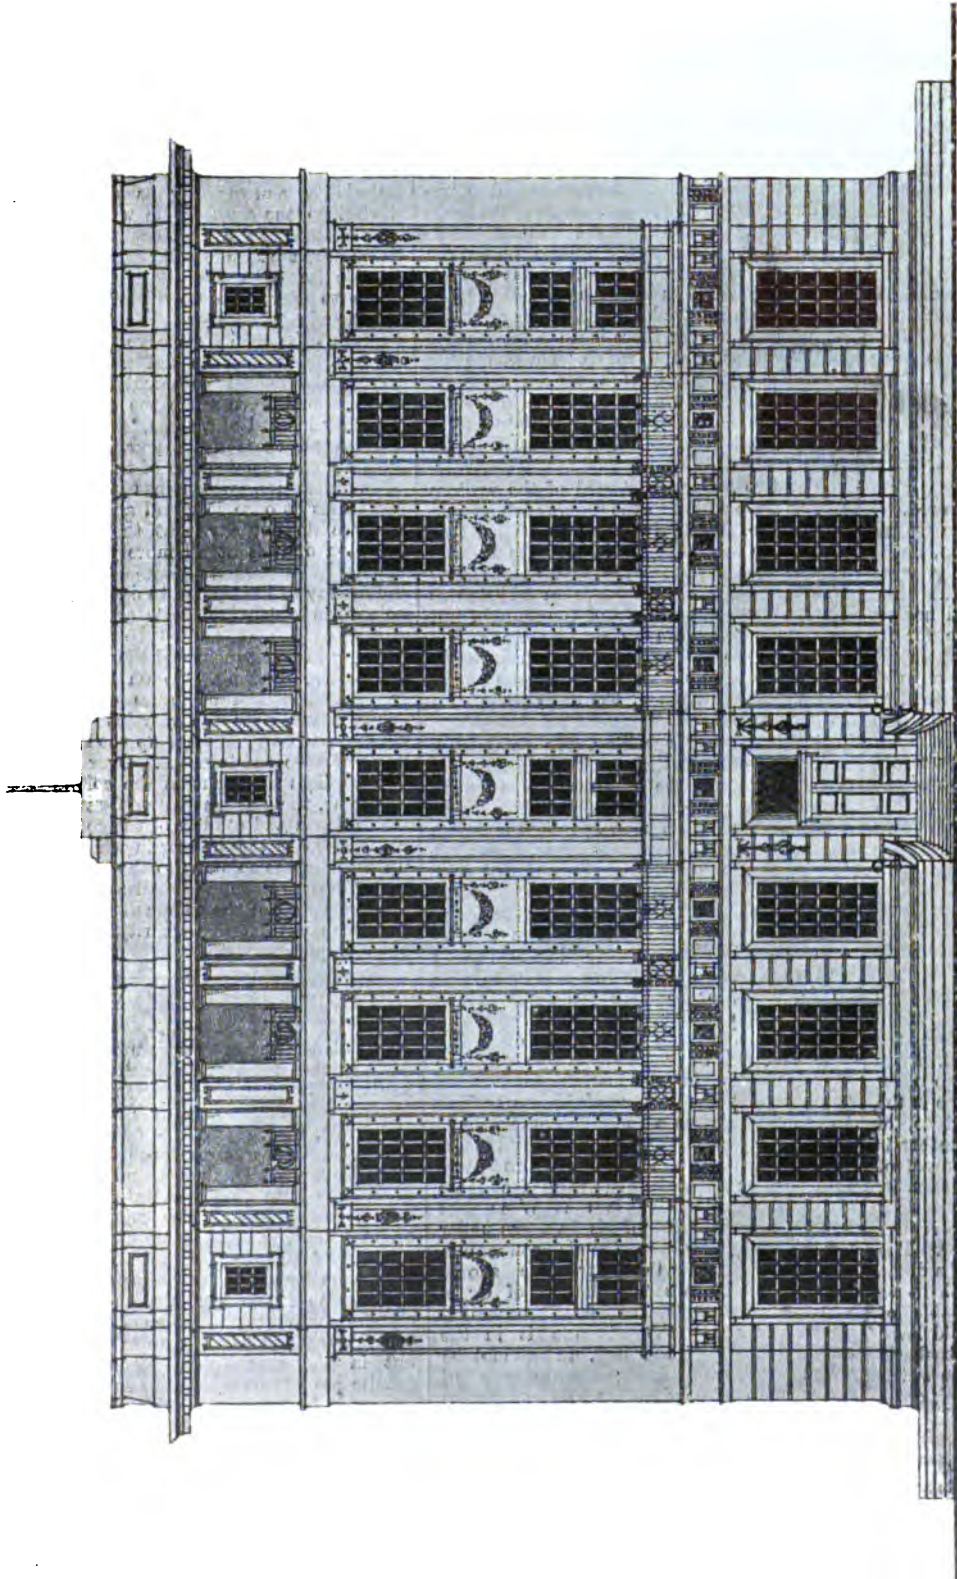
Aus dem Wettbewerb für die Schauseite eines Klubhauses in Eisenbeton.
